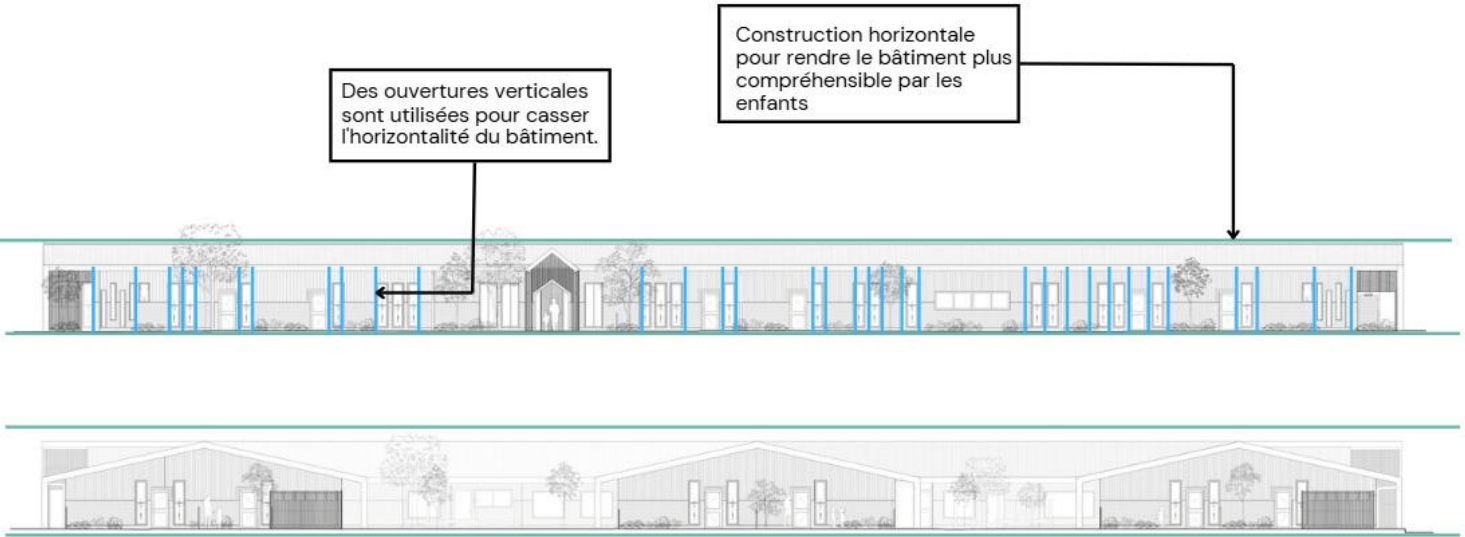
les coupes (source : Guymer Bailey Architects ; archdaily)
